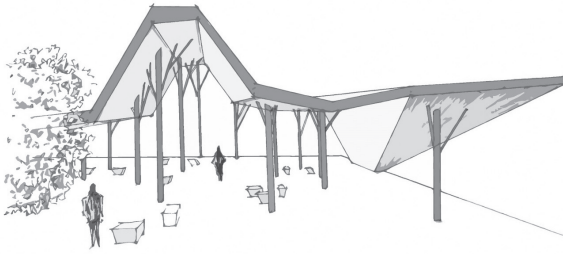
Pabellón en el cementerio de Pardesiya de Ron Shenkin, 2015.
